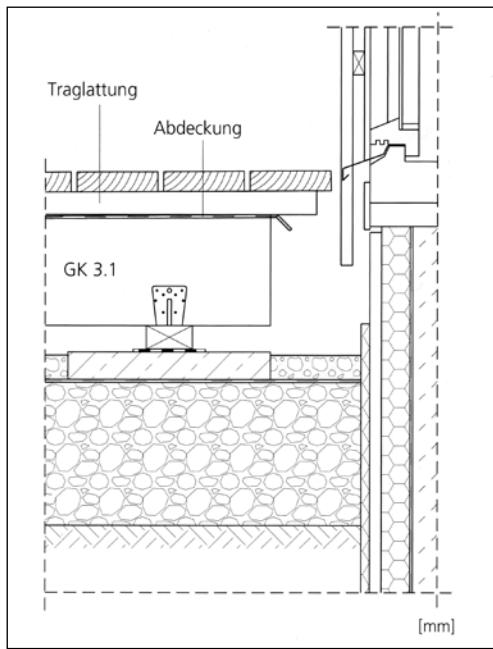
■ Prinzip einer offenen Terrassenkonstruktion ([49], S. 24)
